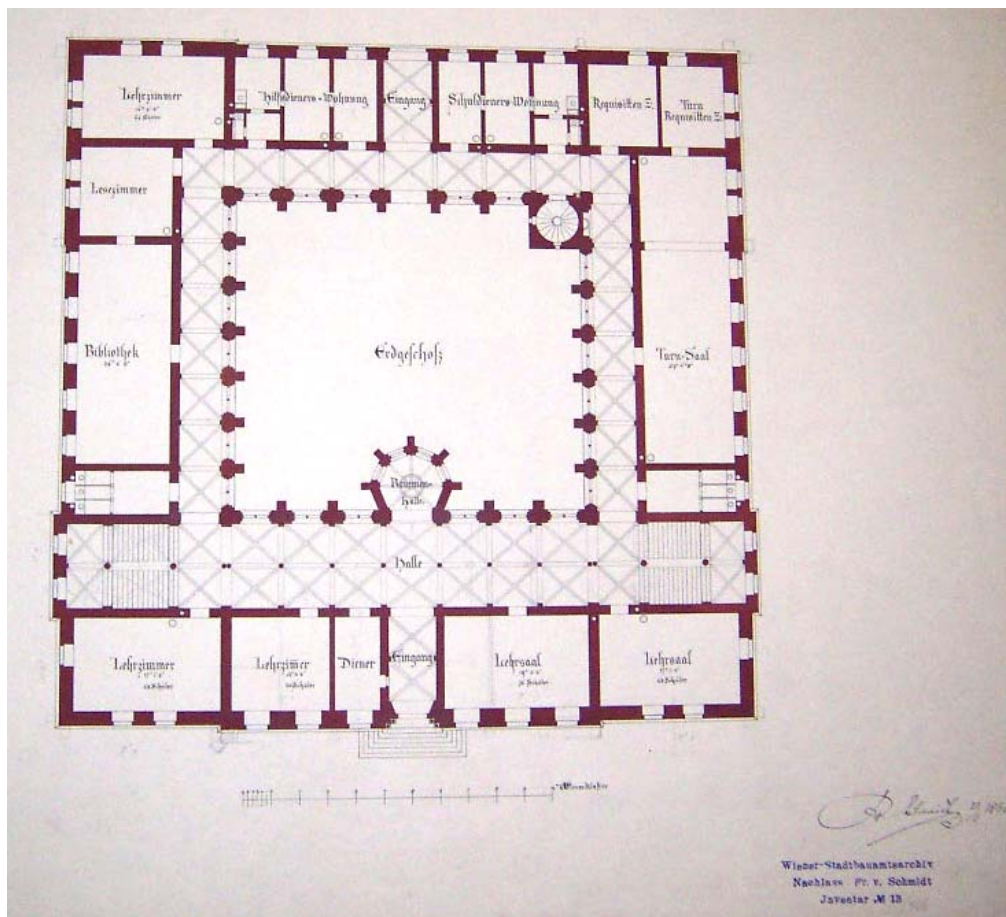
Grundrissplan, Erdgeschoss, 1862
